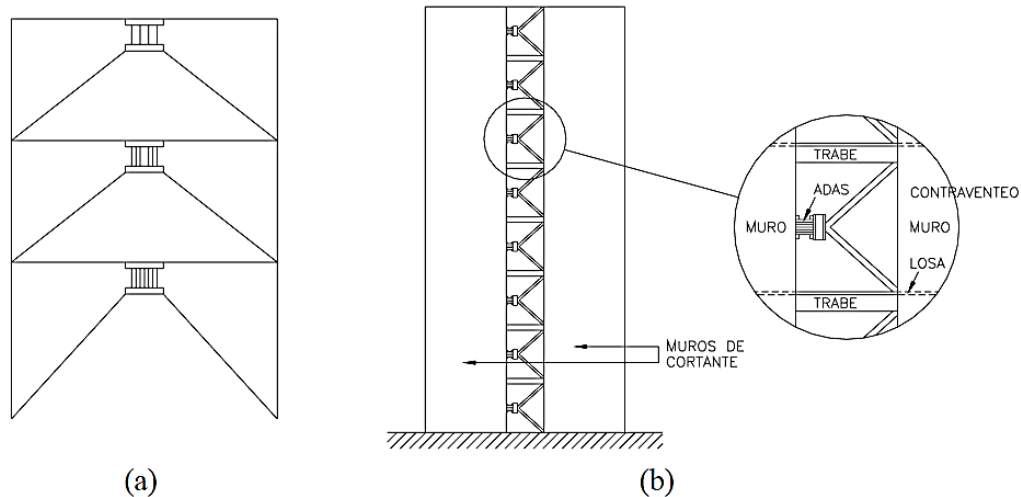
8. Ubicación del sistema ADAS en muros de hormigón (Whittaker et al., 1989).
